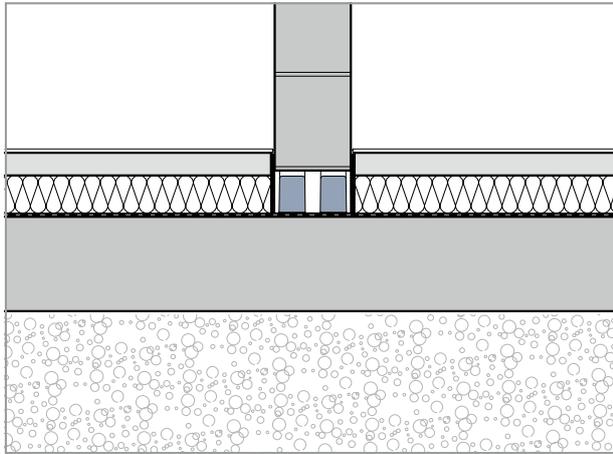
Schöck Sconnex® type M internal wall on foundation component
